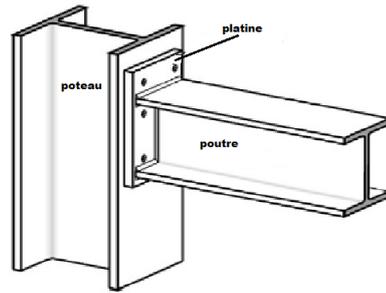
Assemblage du poteau avec la poutre métallique ¹²⁶
